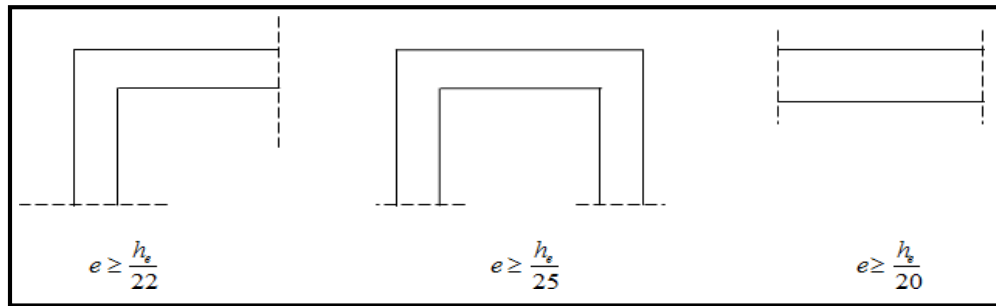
Épaisseurs des voiles - coupe en élévation.
